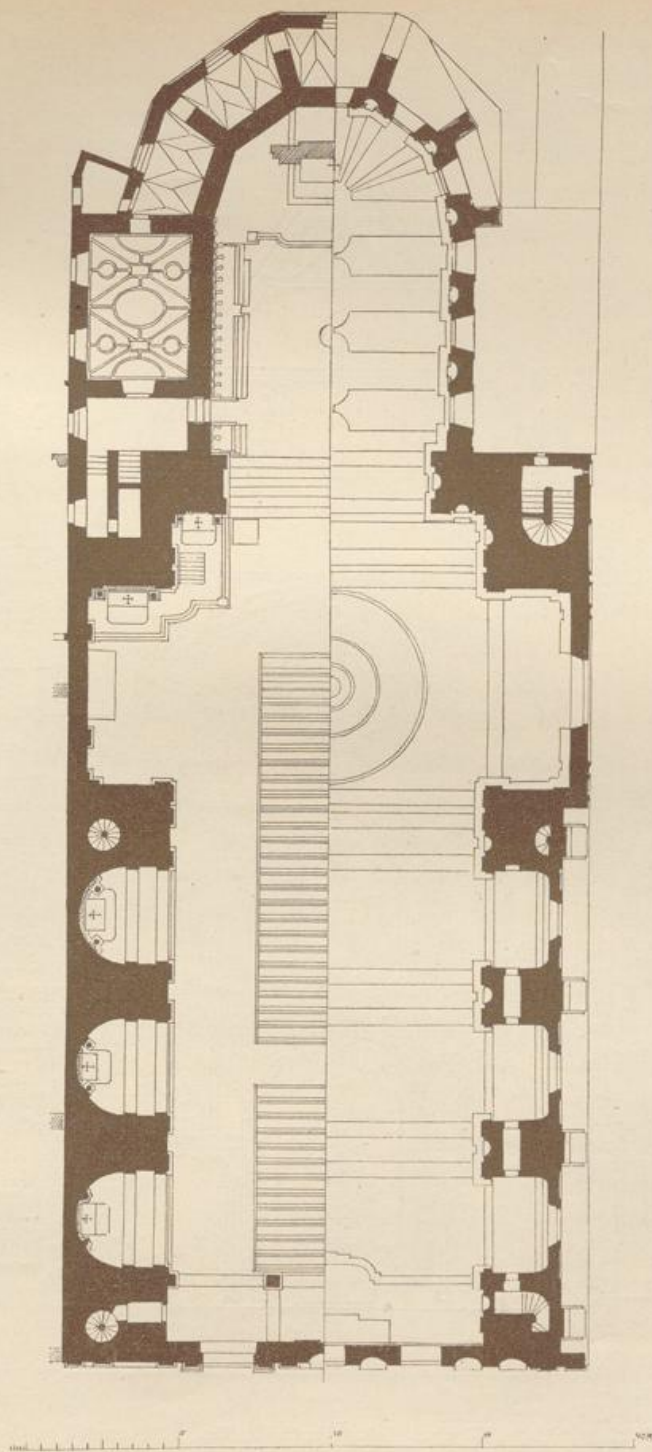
St. Michaelskirche, München. Grundriss (n. Ortwein).
